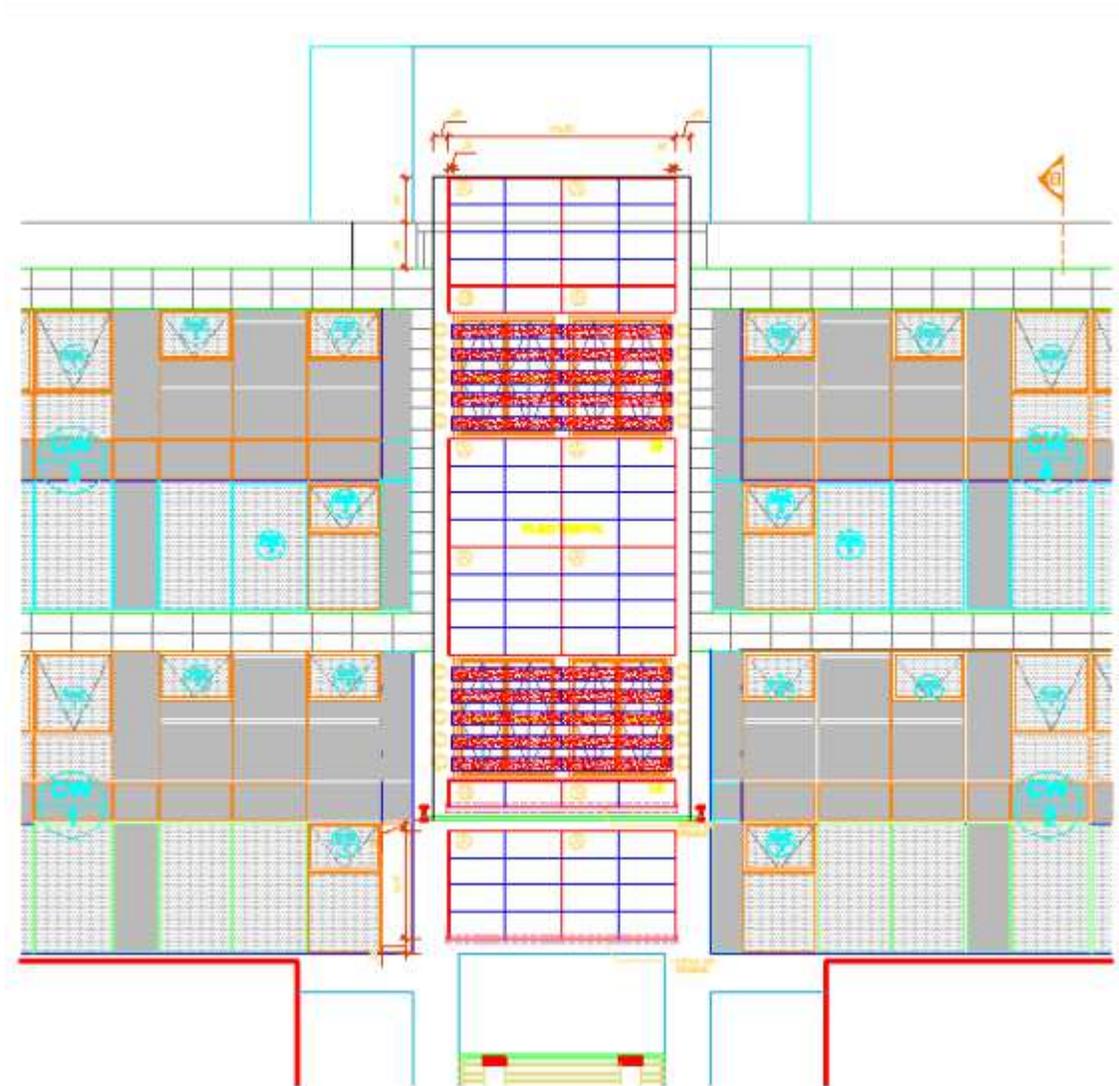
Plano esquemático, cortesía de TIP Proyectos
